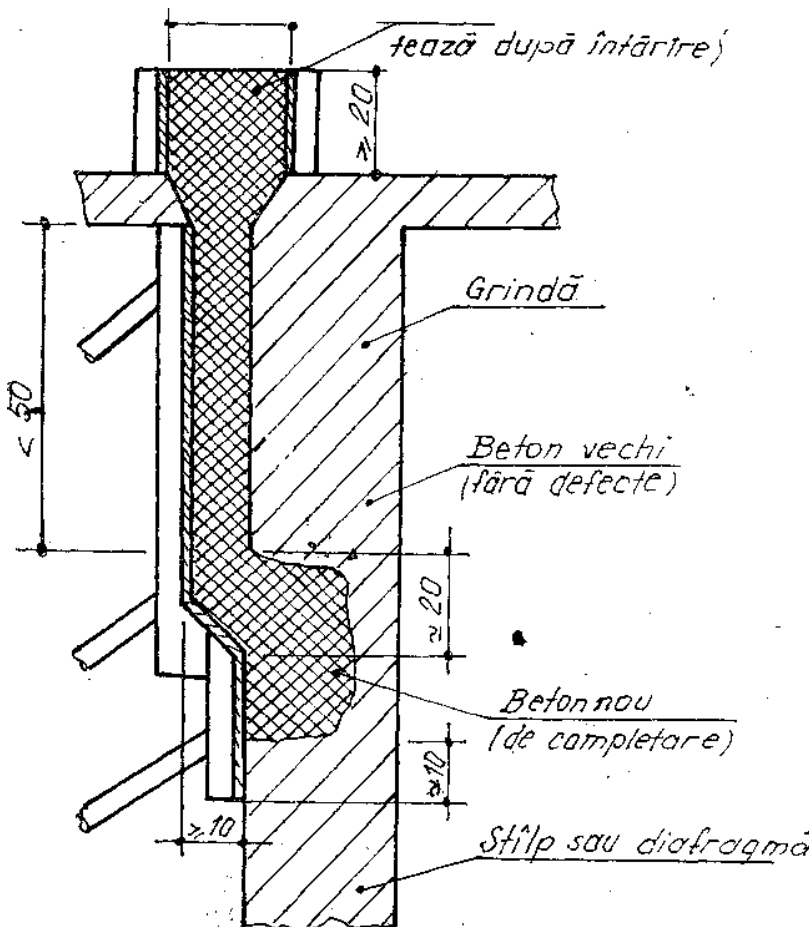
Cazul elementelor la care există spațiu suficient pentru manevrele de betonare și manipulare a pervibratoarelor.
